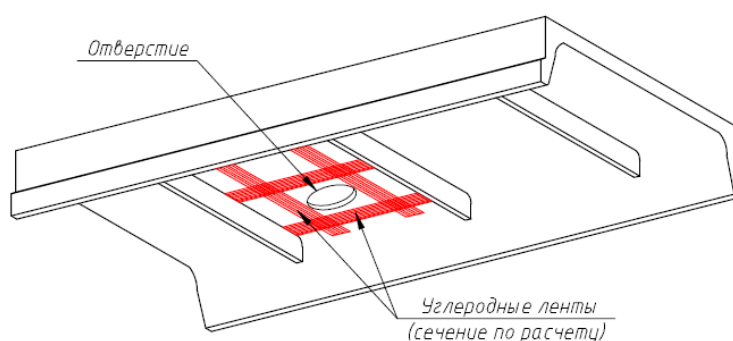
Принципиальная схема усиления проема в стене и перекрытии
